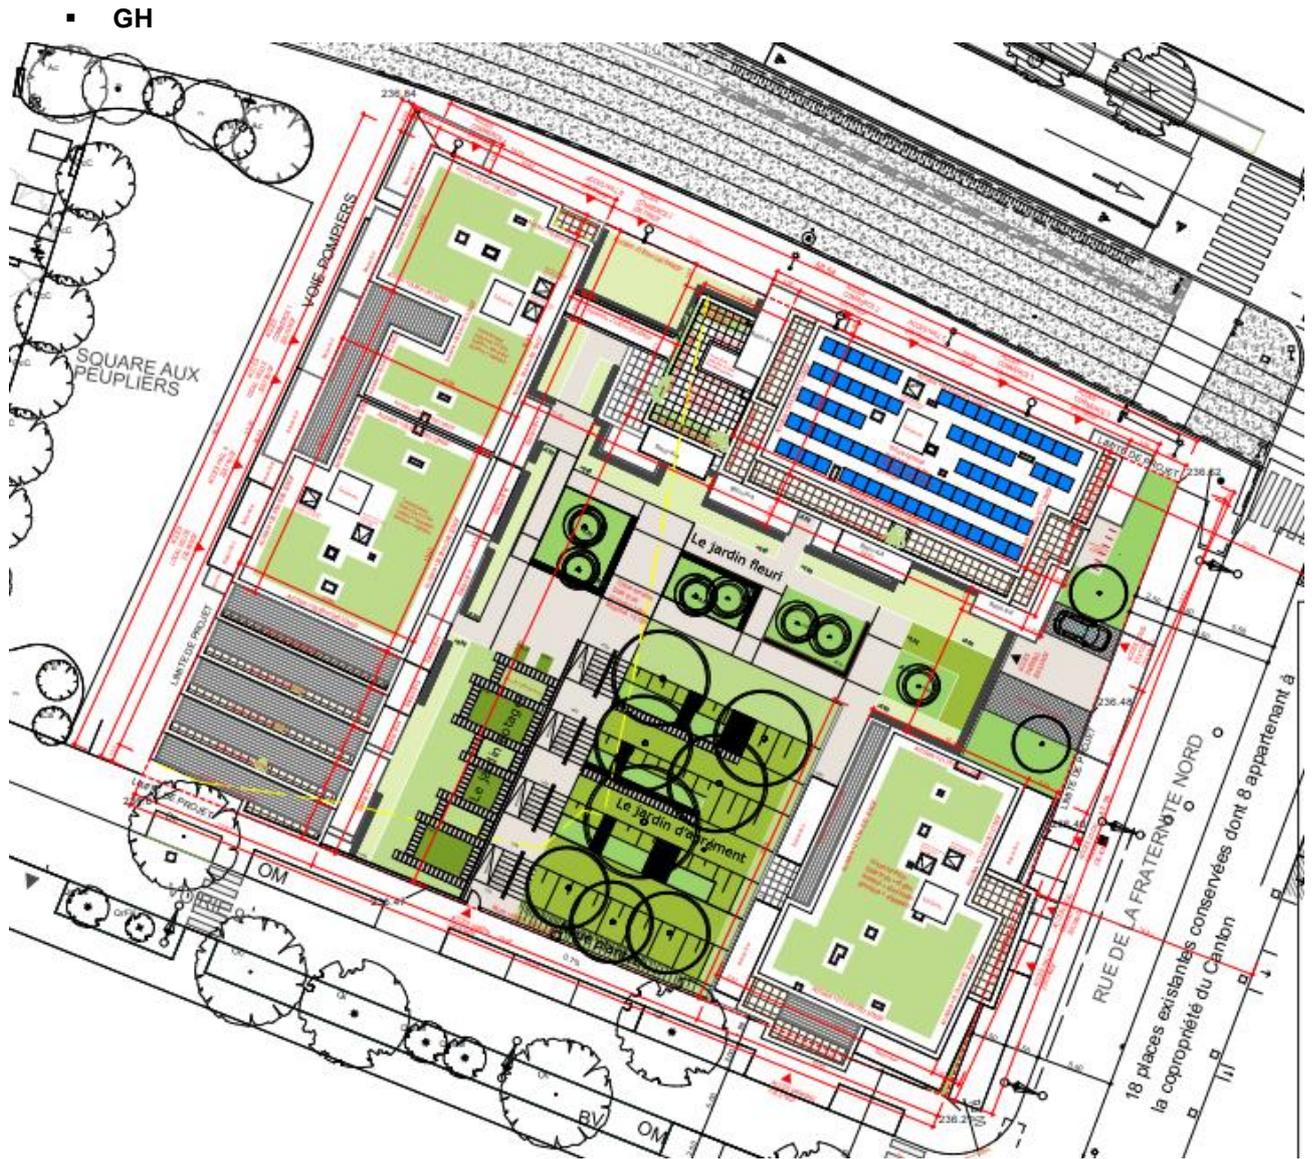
Plan de masse paysage du lot VA4 dans le cadre de son permis de construire
